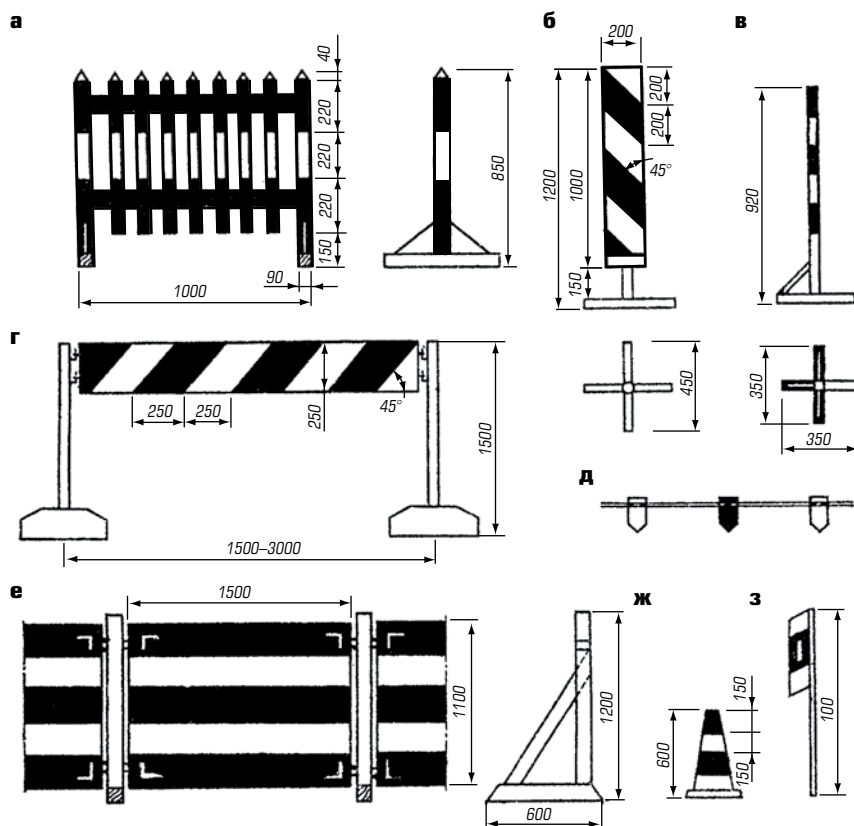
Ограждения и направляющие устройства: а — штакетный барьер; б — направляющая вежа; в — деревянная стойка; г — барьер с деревянной или металлической перекладиной; д — сигнальный шнур с цветными флажками; е — инвентарный щит; ж — направляющий конус; з — сигнальный флажок
